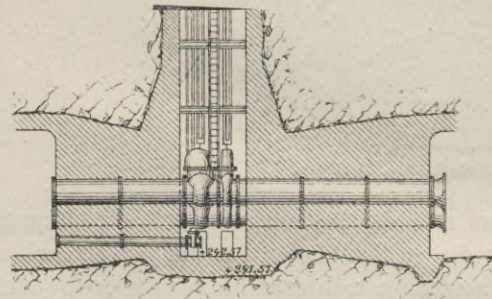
Schnitt durch die Abmauerung und Anordnung der Schieber in den Grundablässen der Umlaufstollen.
